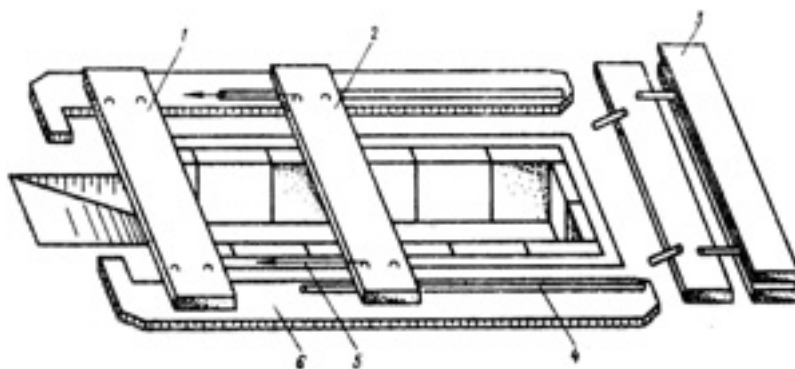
Укладка плит покрытия вручную способом надвигки: 1 – плита в проектном положении; 2 – надвигаемая плита; 3 – штабель плит (две плиты по высоте); 4 – лежни из подтоварника 10–12 см; 5 – тросы (канаты) для перемещения плит; 6 – грунтовая подсыпка толщиной 10–12 см
